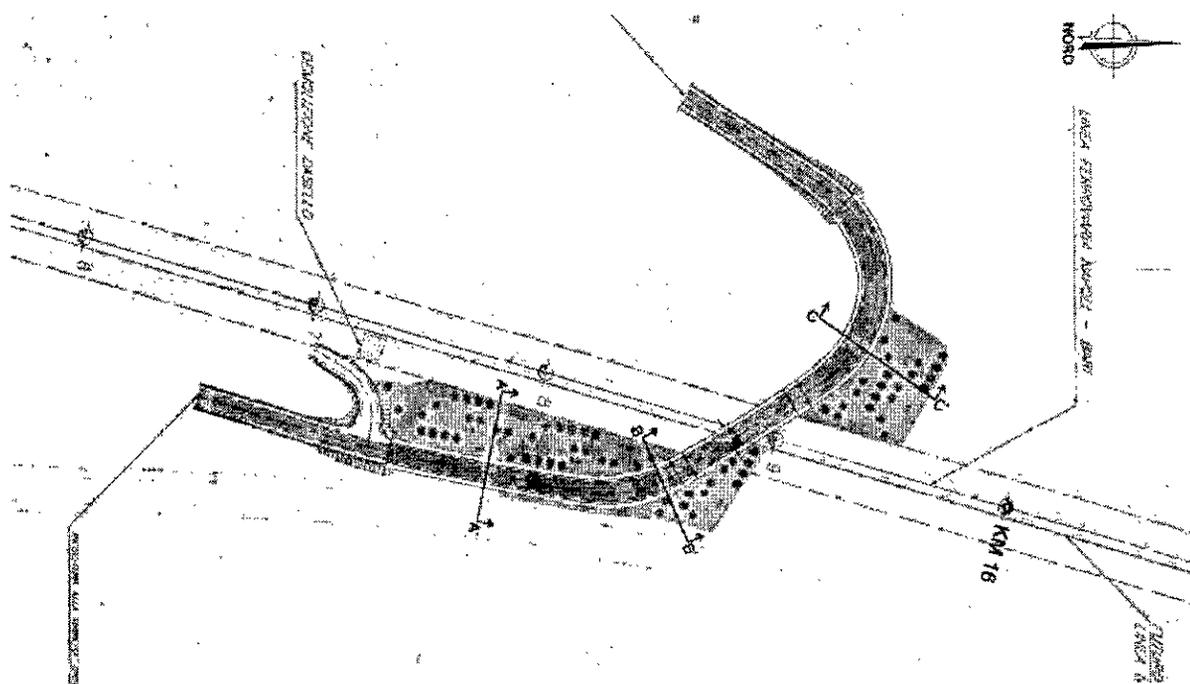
Stralcio della Tavola "Progetto delle opere a verde – planimetria, sezioni e sesto d'impianto" (estratto dal Progetto Definitivo)
